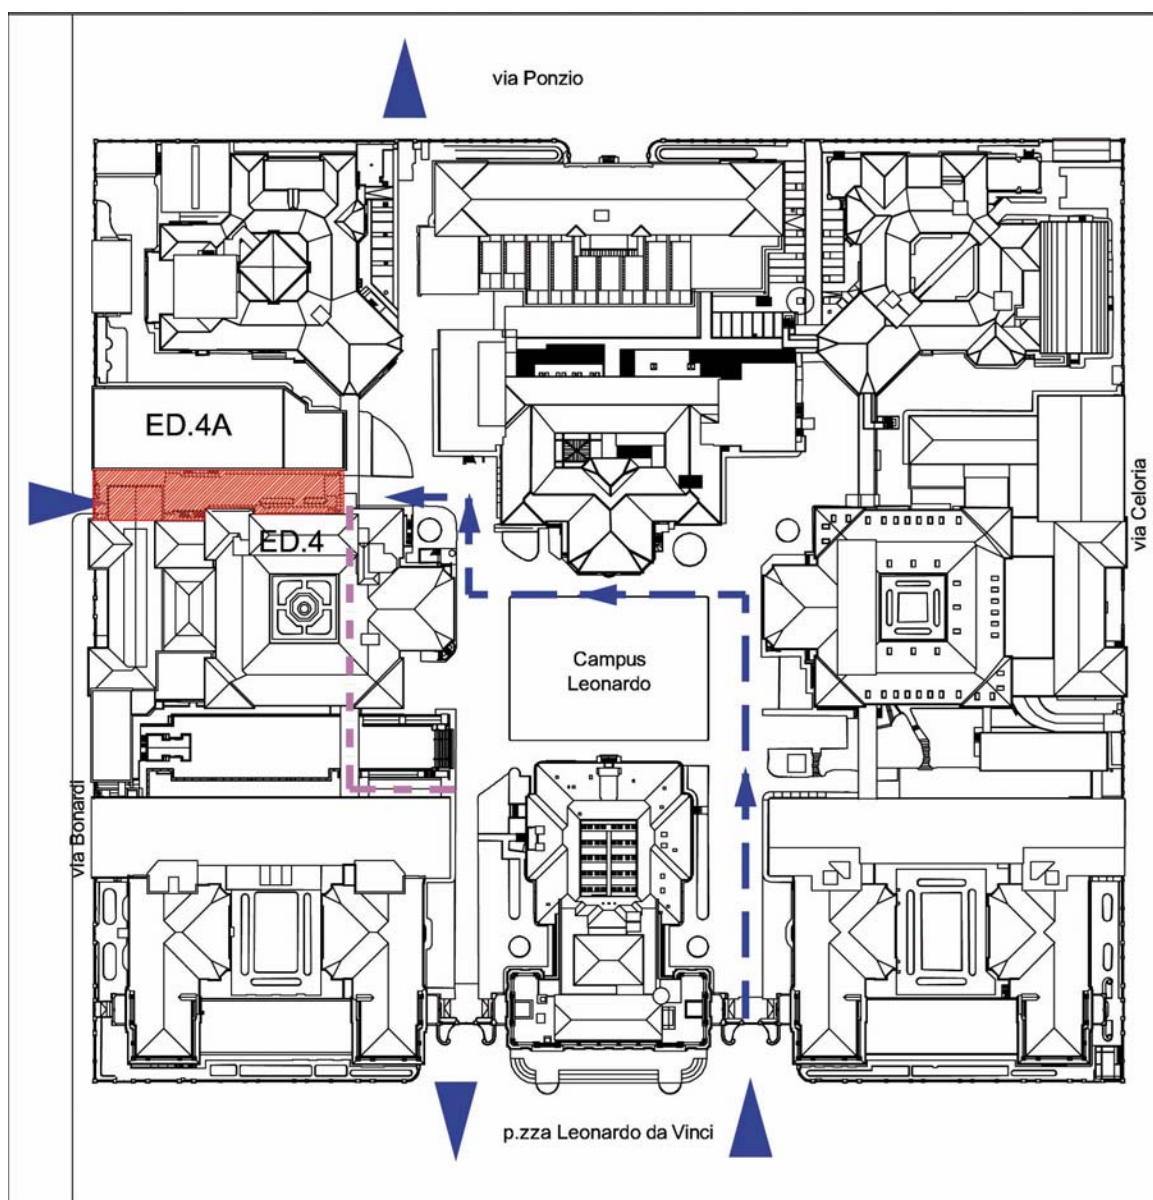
Planimetria del campus con evidenziata l'area oggetto di intervento
